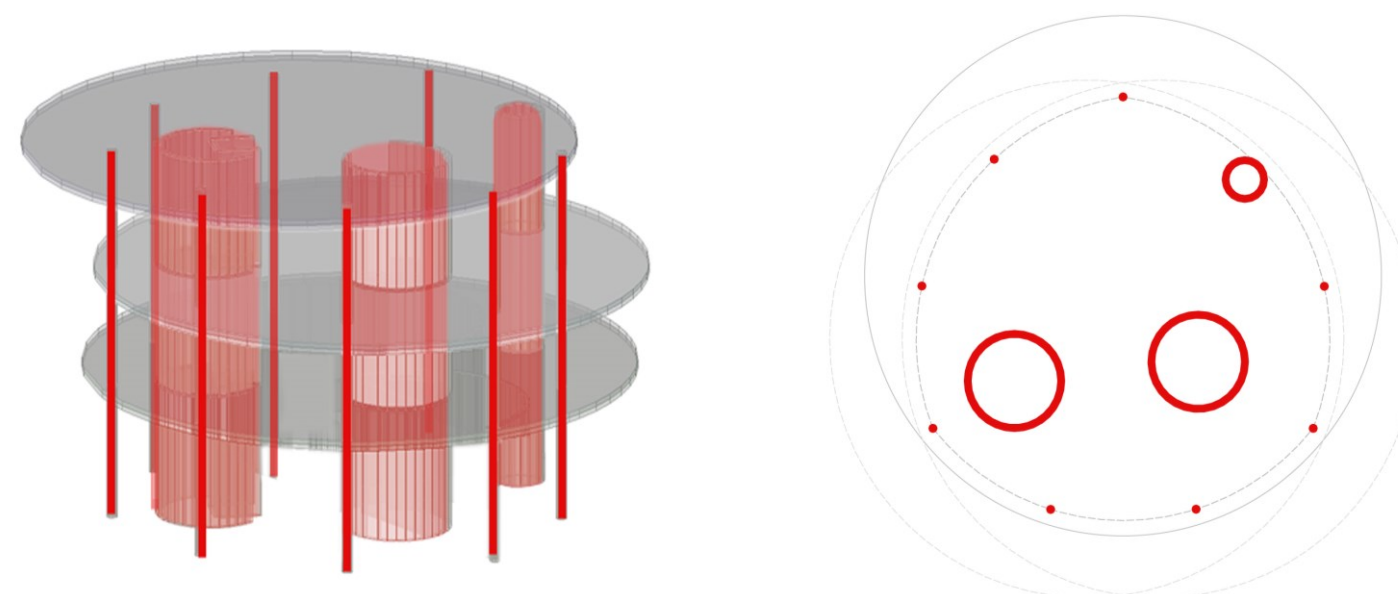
Modello numerico con elementi "shell" (solai e pareti) e elementi di tipo "beam" per i pilastri
